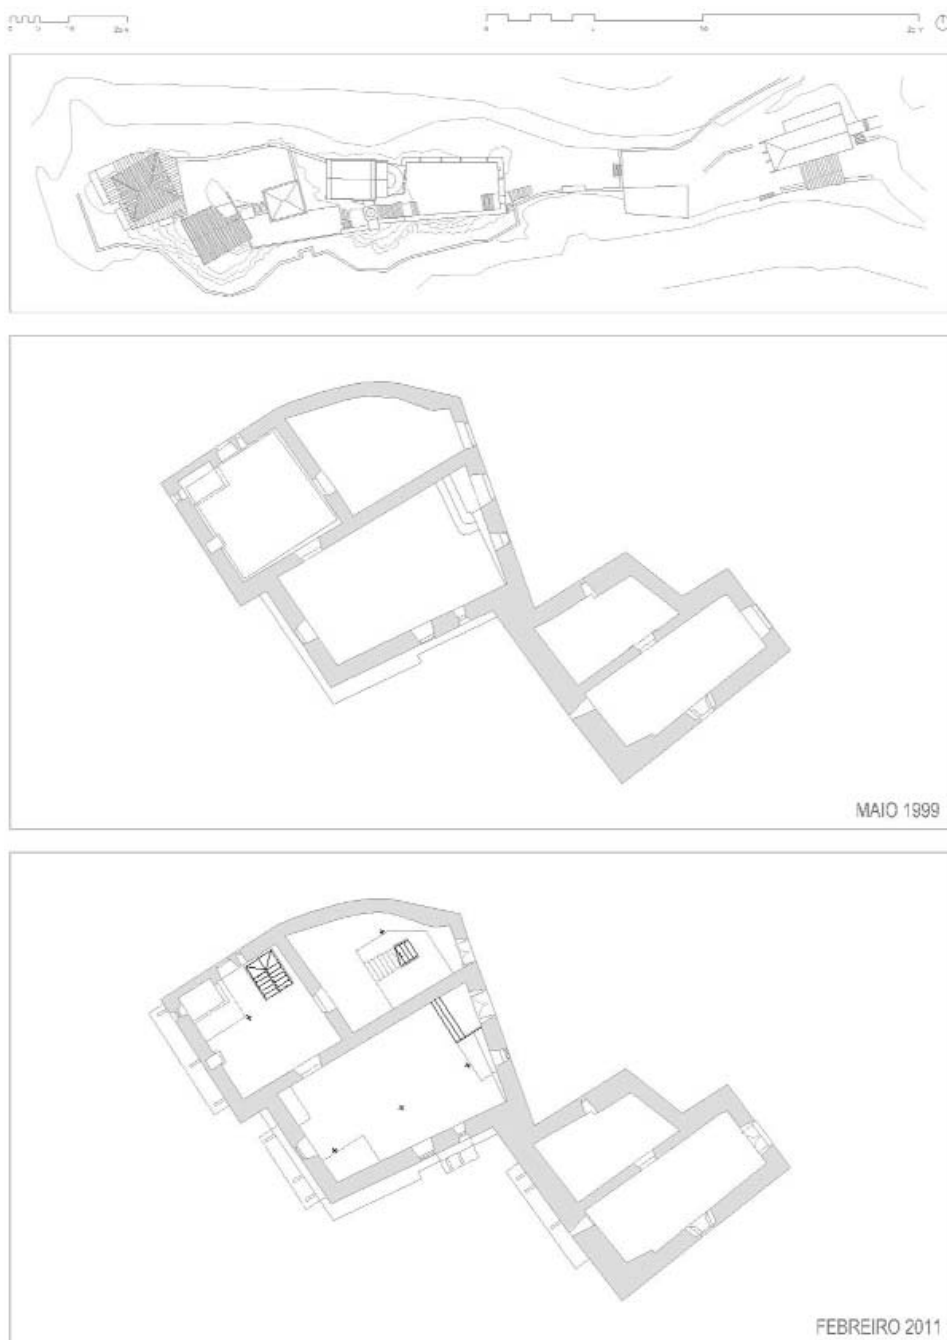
CAAVEIRO. Planta de entrada da Casa de Quintás (Pavillón de exposicións)“
